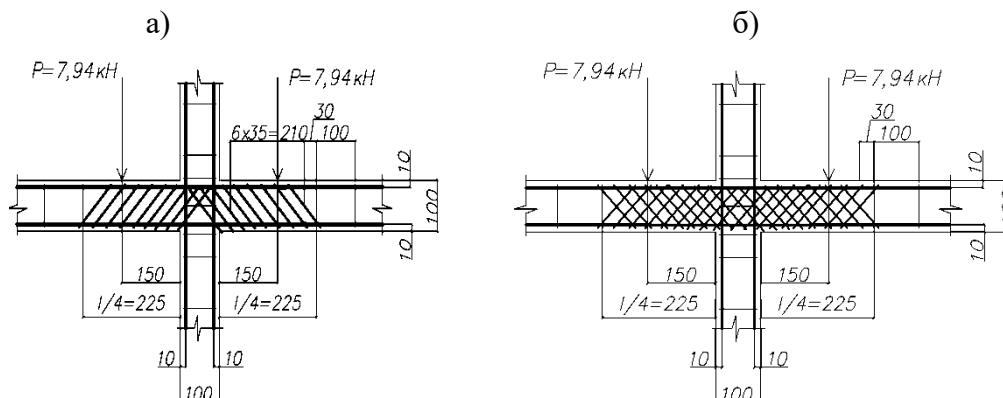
Схема приопорного узла, армированного наклонными стержнями, рама РЖ-1 (а) и с перекрестной схемой армирования, Рама РЖ-2 (б)
